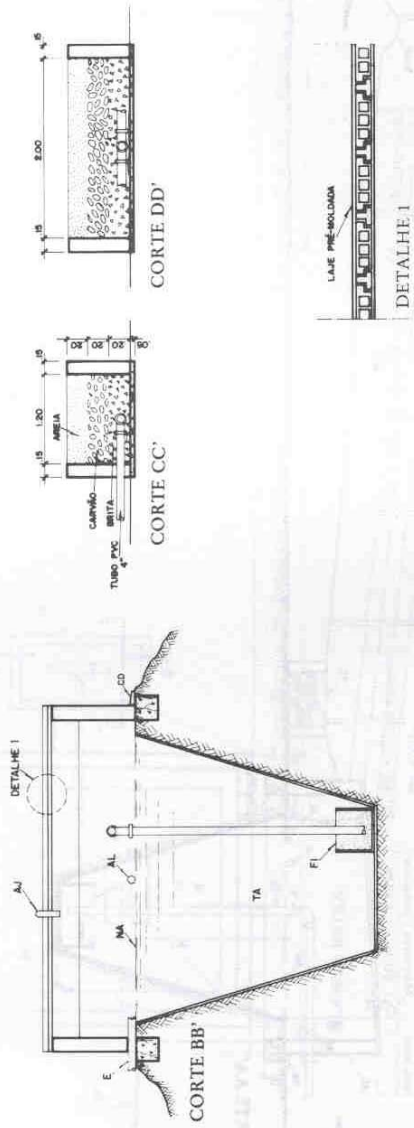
Cortes BB', CC', DD', e detalhe da laje pré-moldada.
